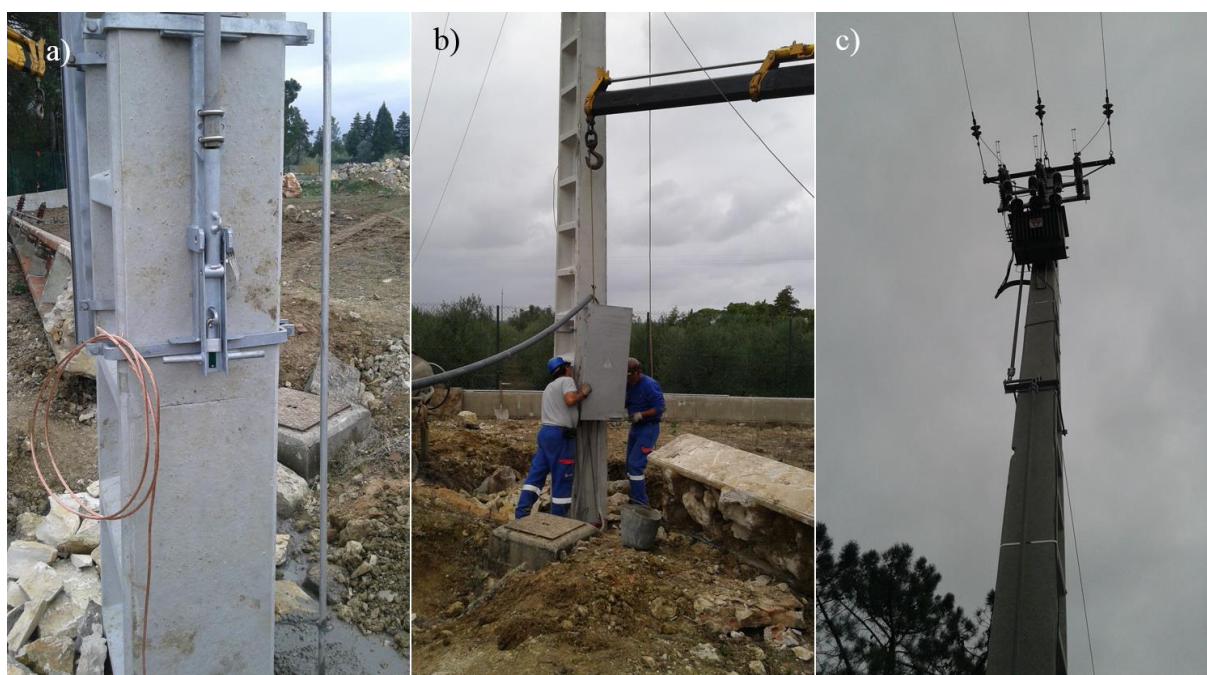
a) Execução do maciço de betão, b) colocação do QGBT, c) transformador de potência colocado no apoio de betão.
